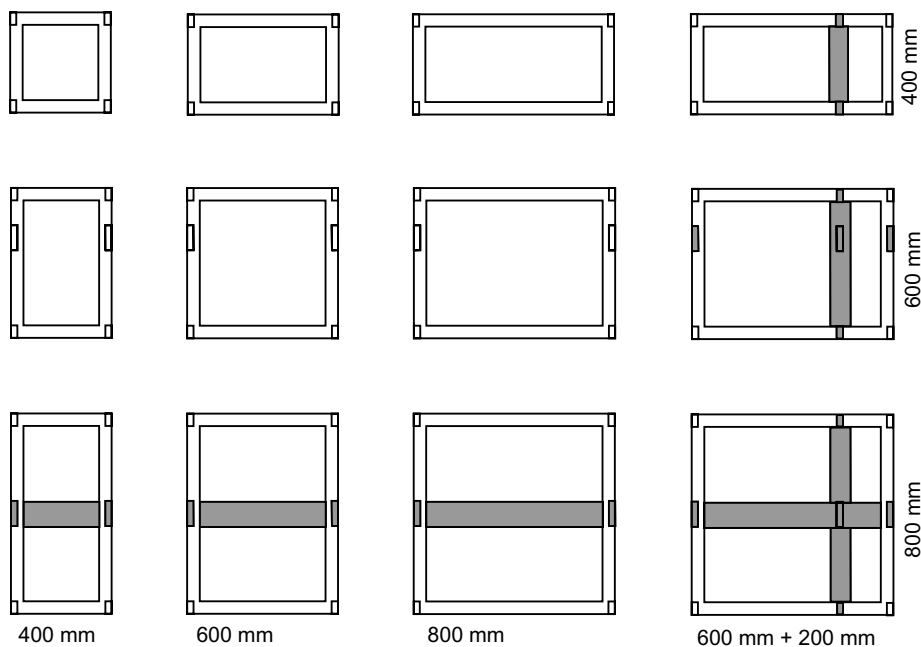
Draufsicht von Gerüsten mit Trägersbau
